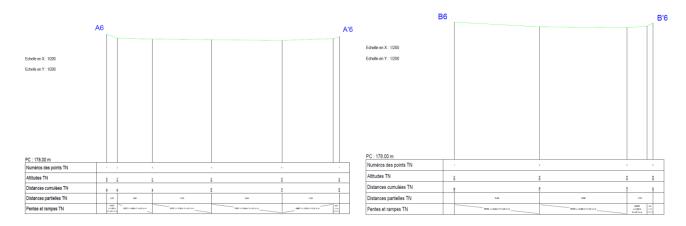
Coupe AA' et BB' du bassin pluvial n°6 de la zone existante Nord
